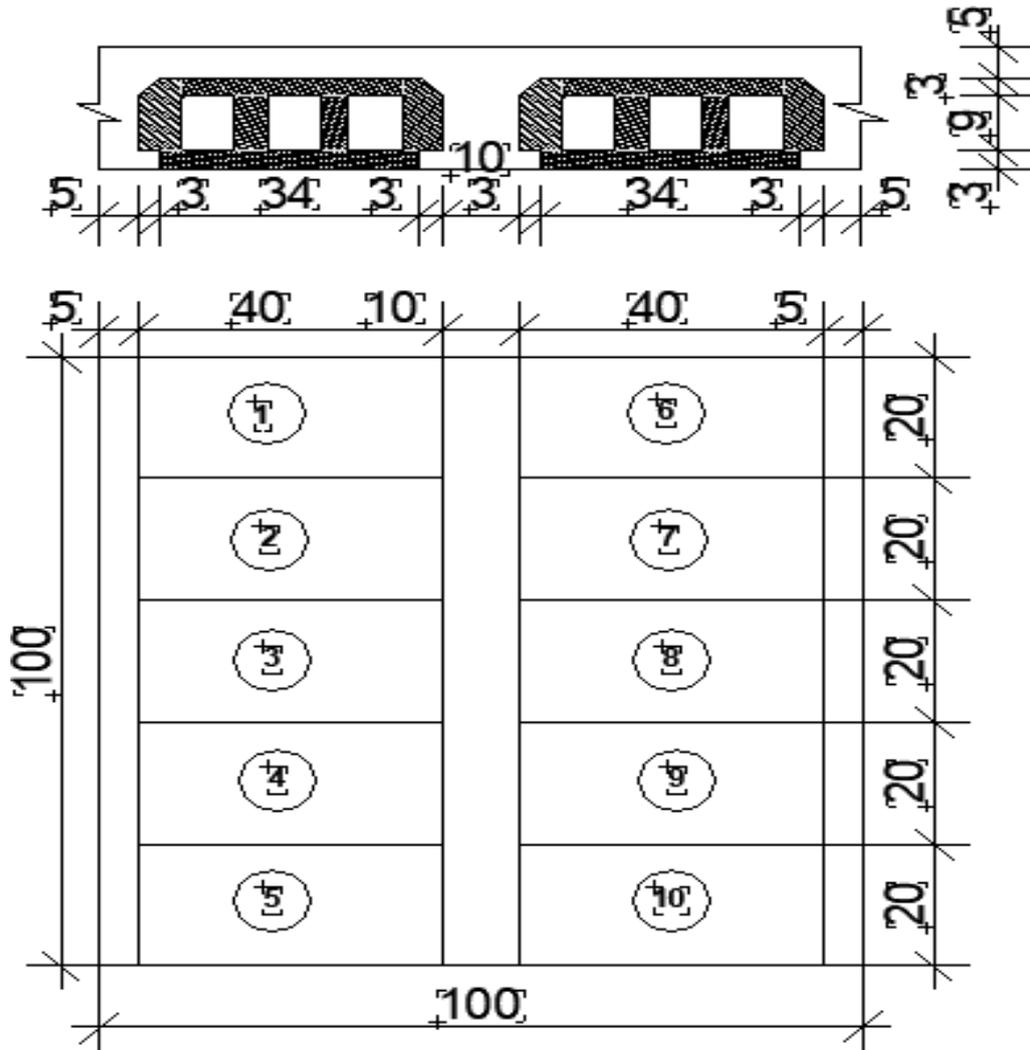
Coupe partielle sur plancher à corps creux (15+5)
